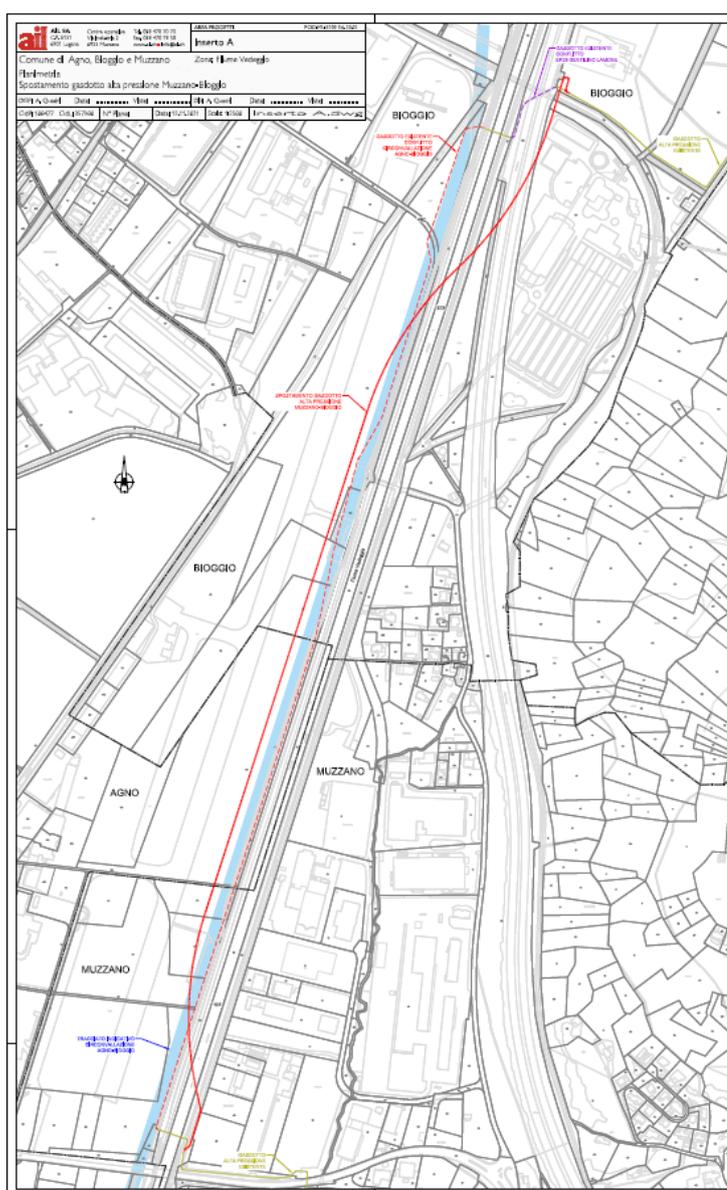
Estratto planimetrico conflitto CAB con gasdotto AIL (tratteggio rosso: condotta attuale, linea rossa: condotta spostata)
